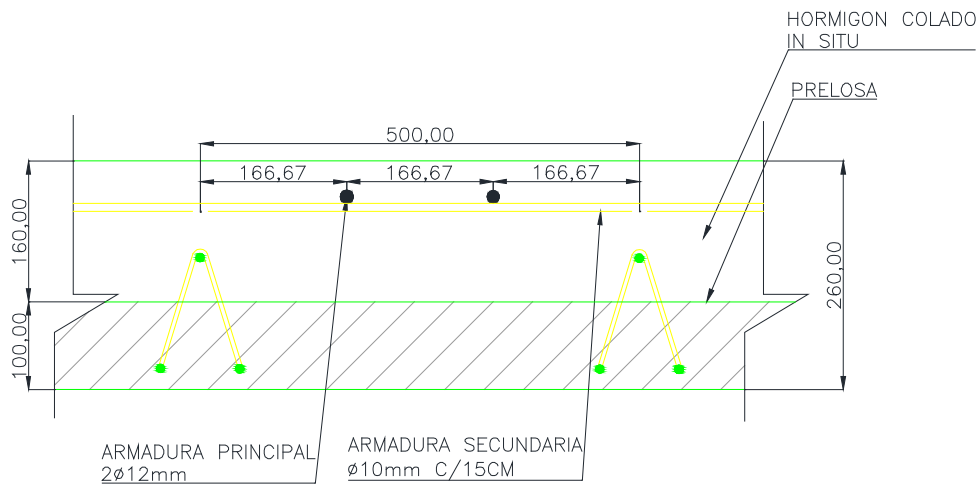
Esquema de armaduras en el apoyo (fuente: elaboración propia).
